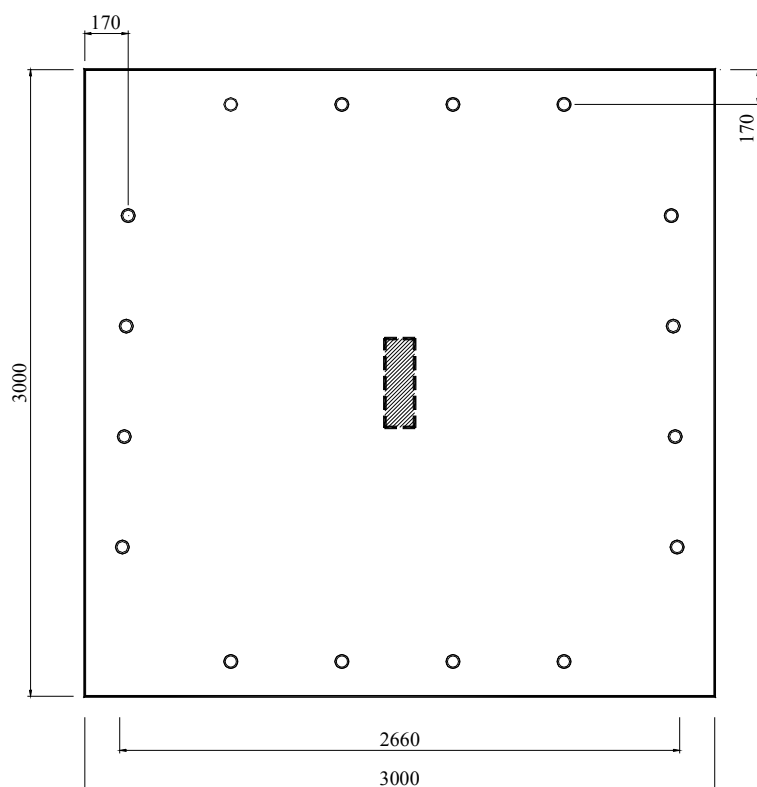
Modelo das lajes ensaiadas por Borges (2003)
